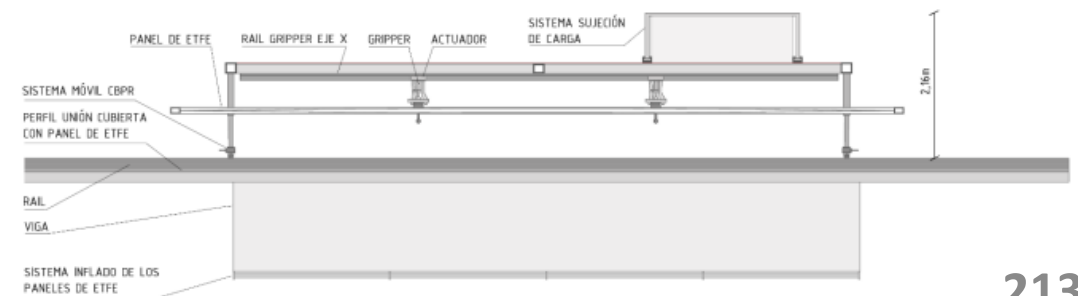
Detalle constructivo del montaje de un cerramiento de EFTE
